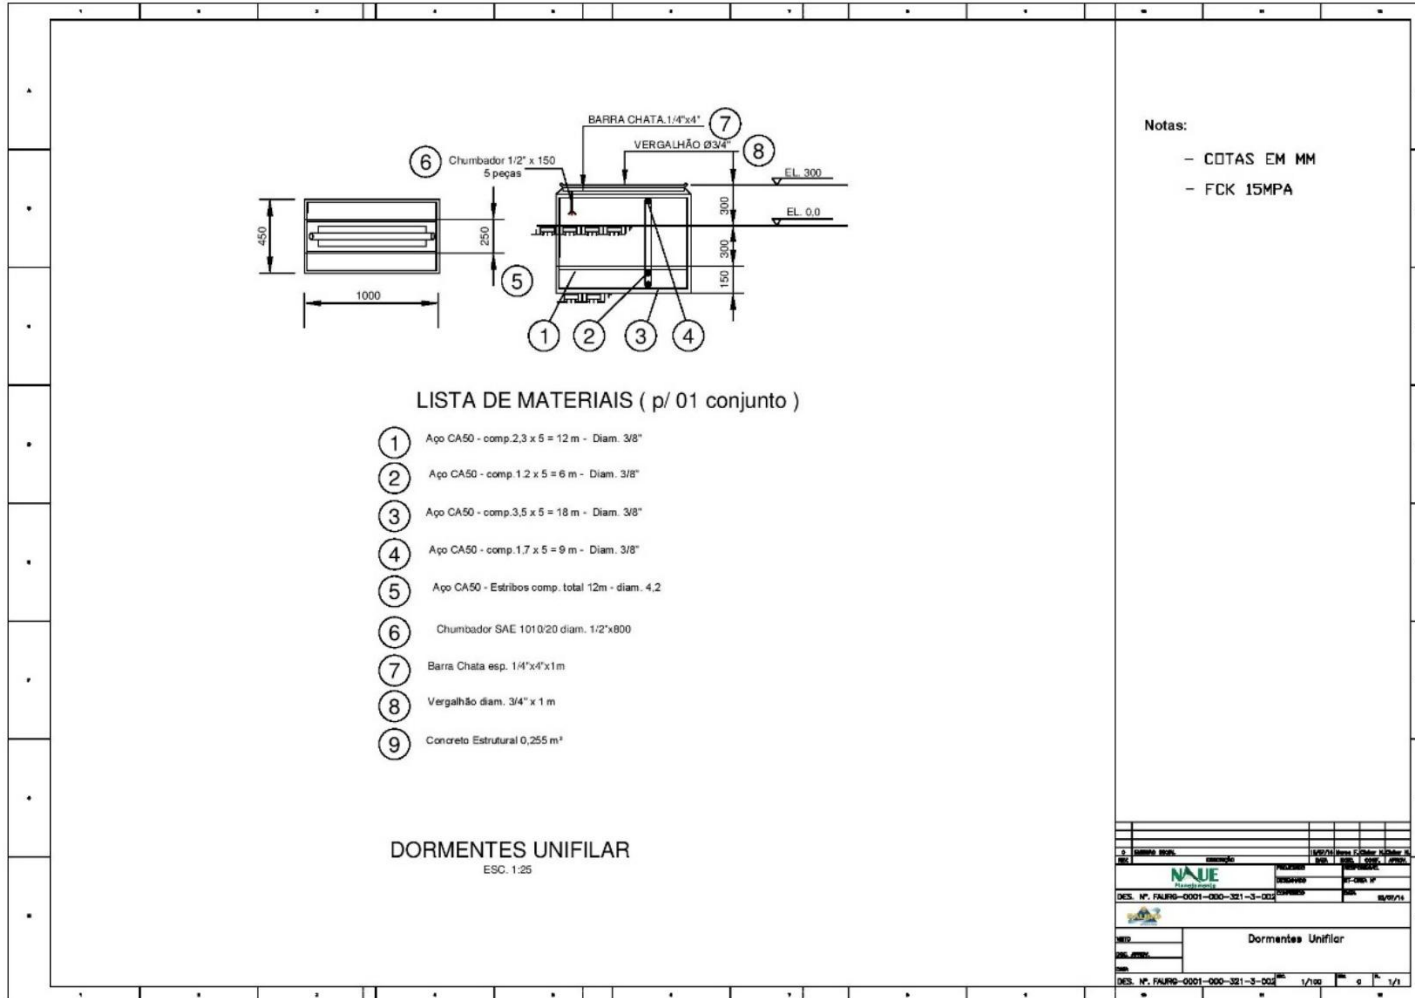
Construção dos dormentes para assentamento da tubulação de gás
